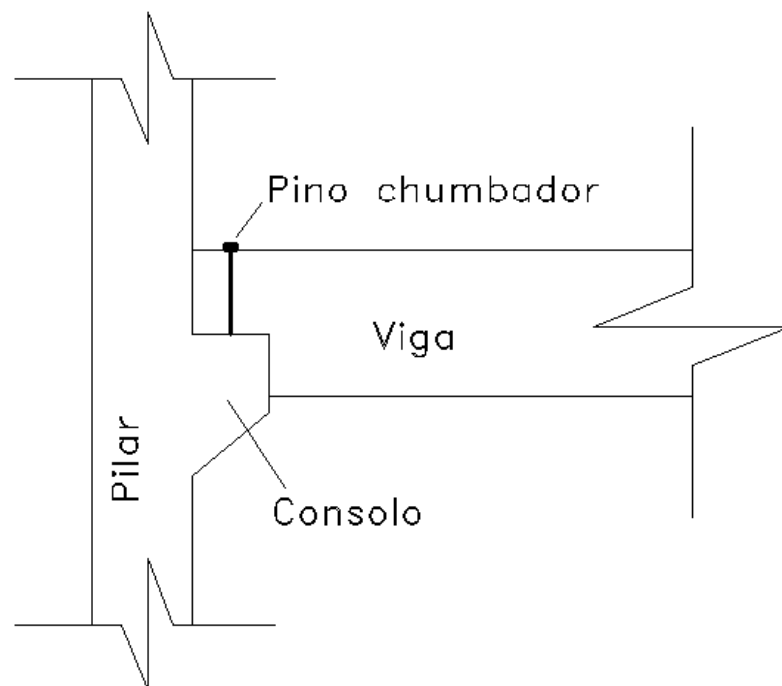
Ligação viga-pilar por consolo horizontal e pino chumbador.
